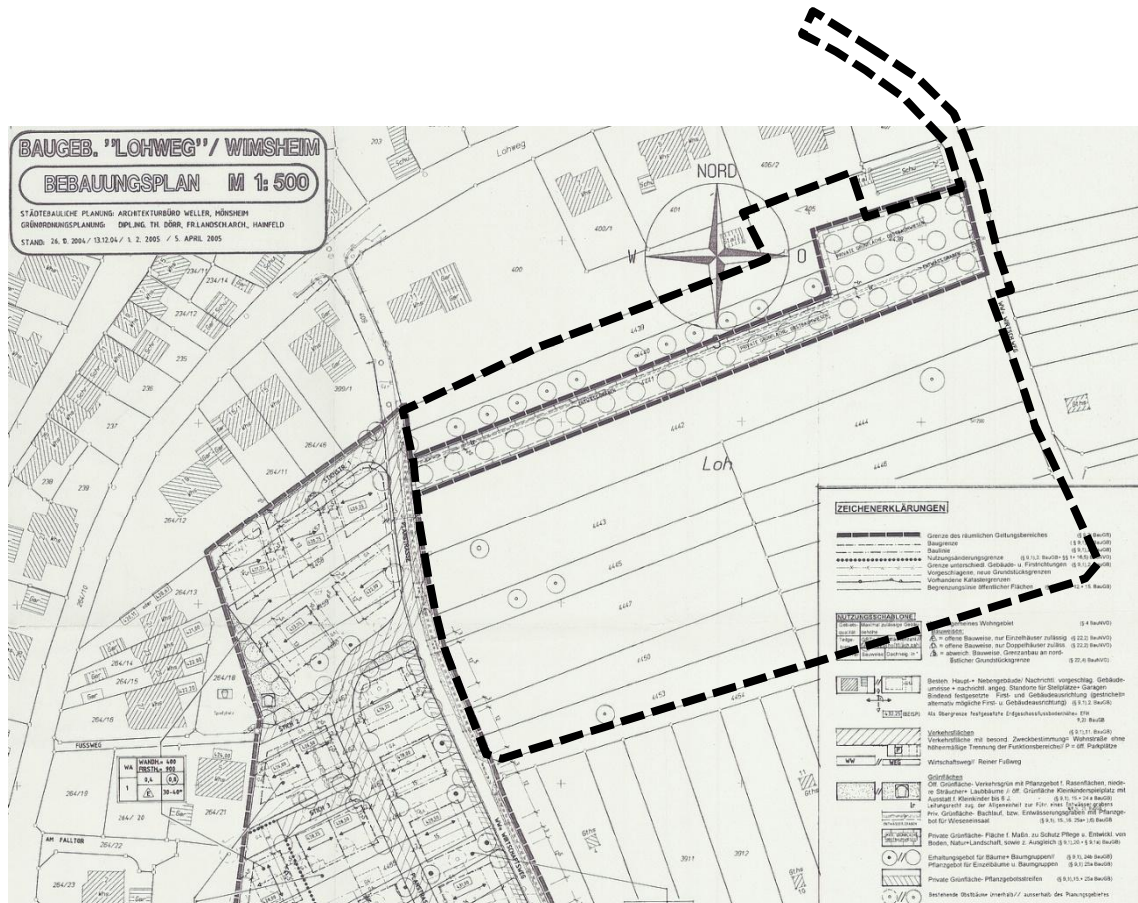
Auszug aus dem Bebauungsplan „Lohweg“ mit Plangebietsüberschneidung
